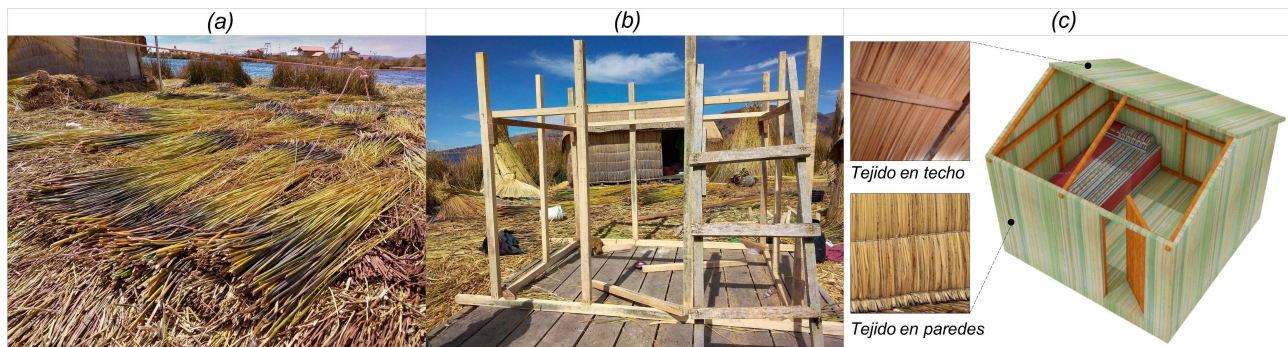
Vivienda Uro - armado. Fuente: Elaboración de los autores.
